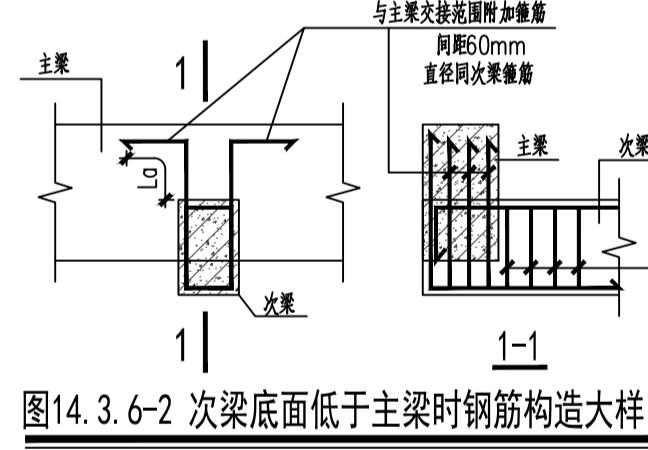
次梁底面低于主梁时钢筋构造大样(一)
